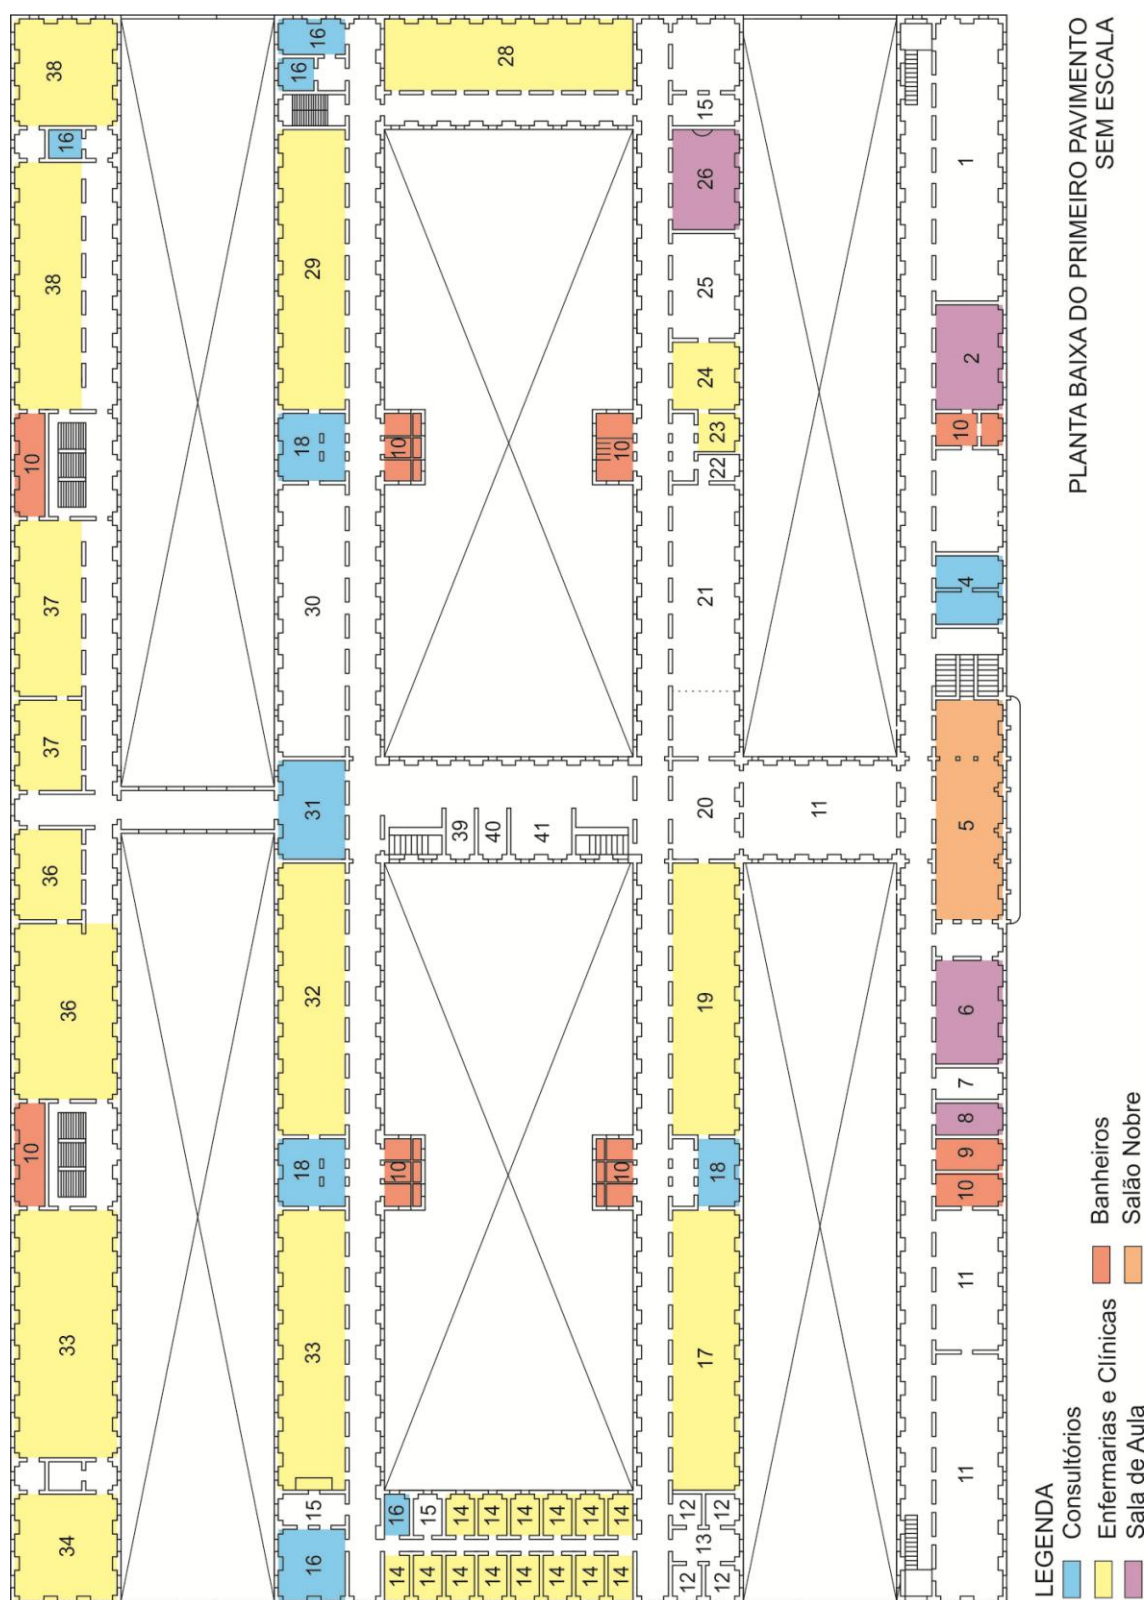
Planta do Hospital da Santa Casa da Misericórdia – Primeiro Pavimento. Fonte: Arquivo Central do IPHAN/RJ, 1938, adaptação da Autora, 2014. [Desenho de Fernanda Trindade].
